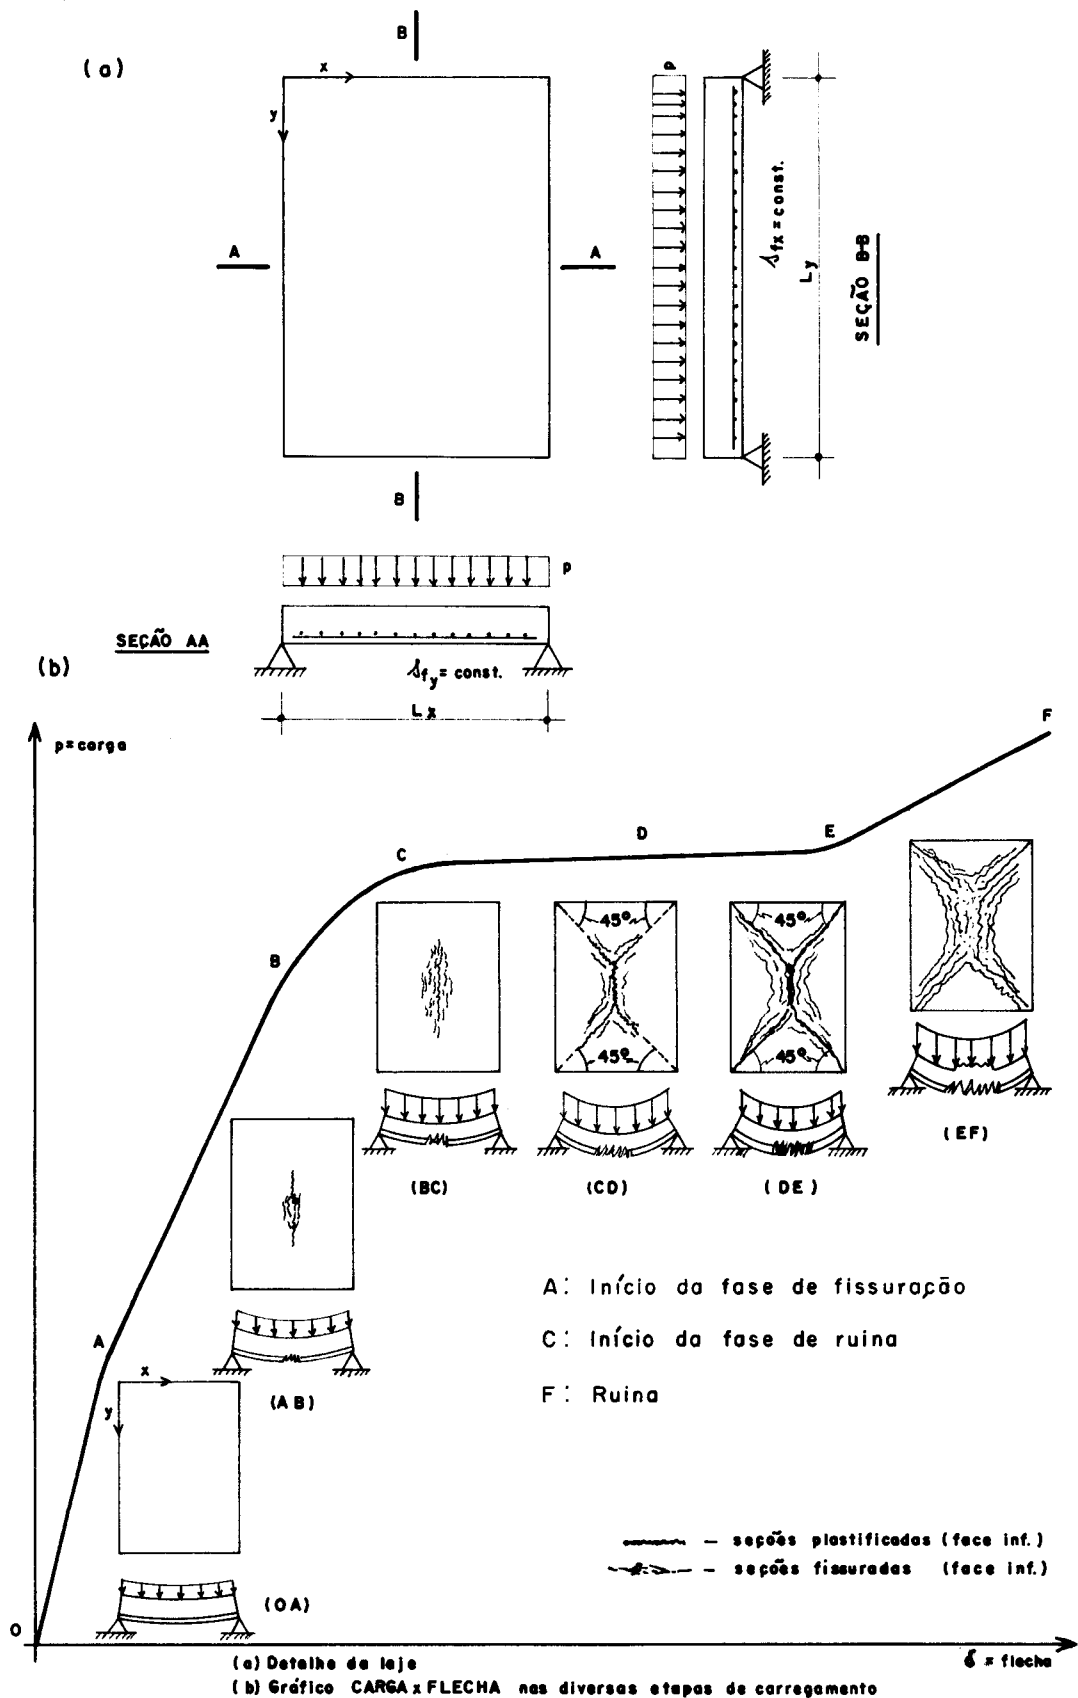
Comportamento de uma laje retangular de concreto armado submetida a carga uniformemente distribuída.
